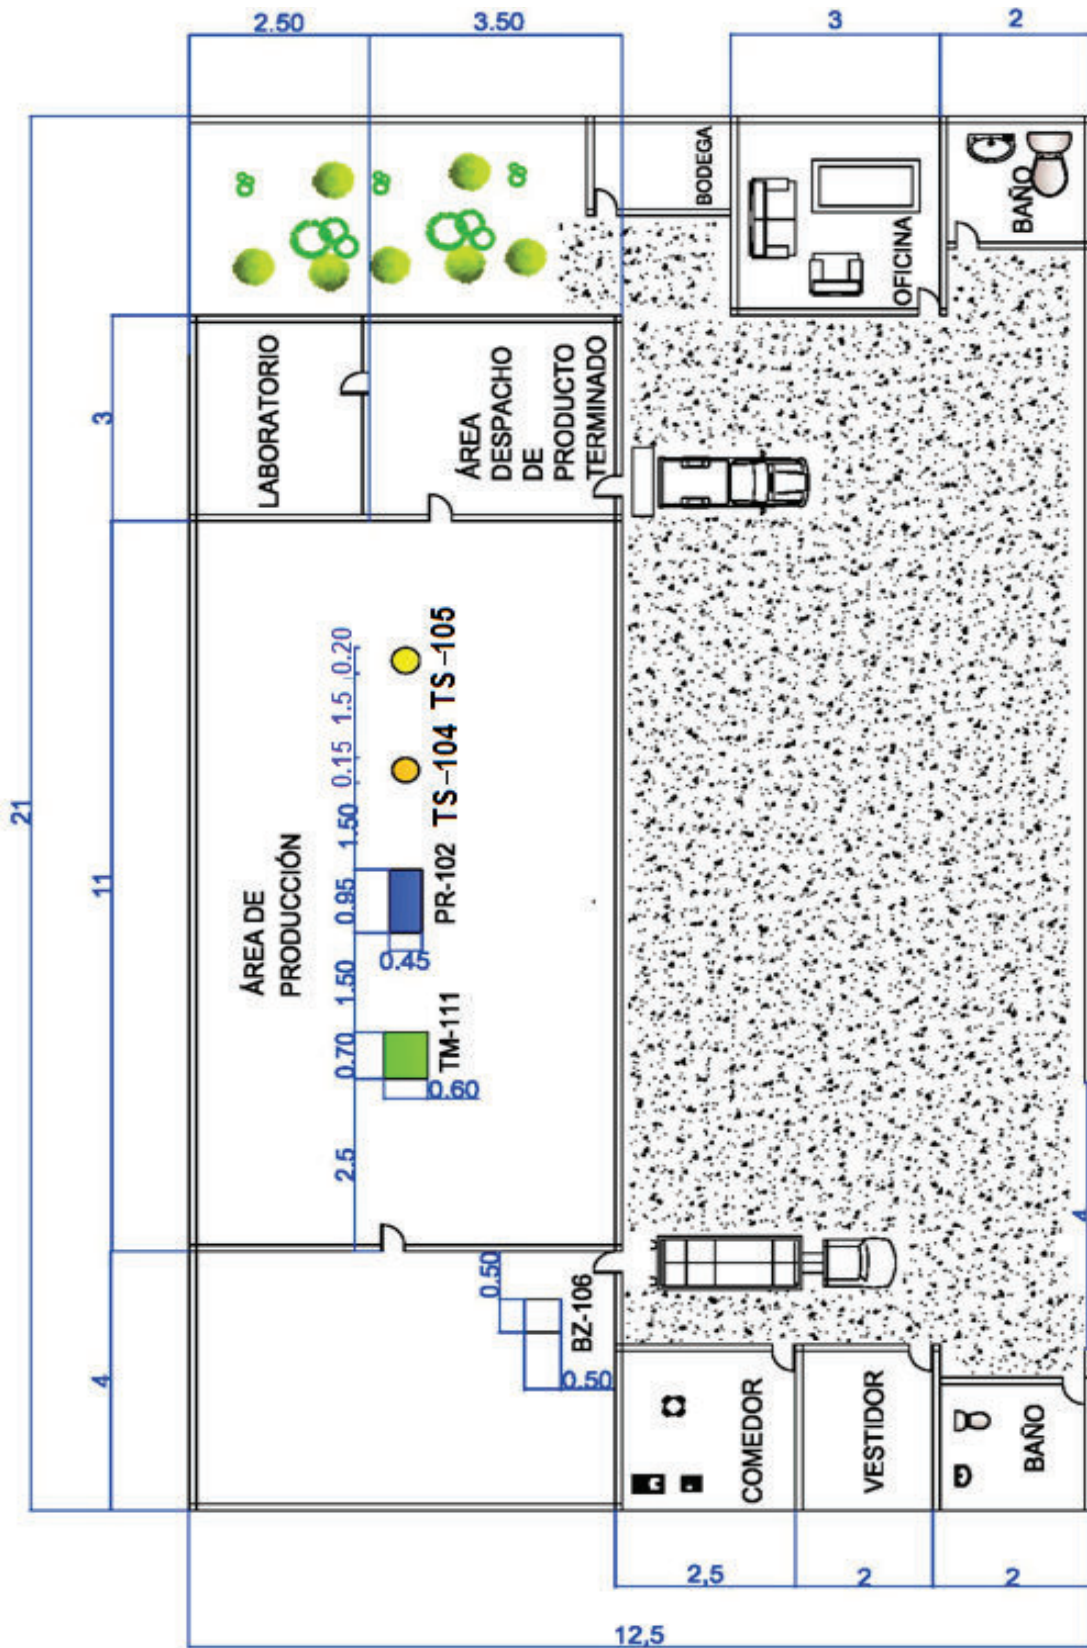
Distribución de los equipos en la planta (LAY OUT)
